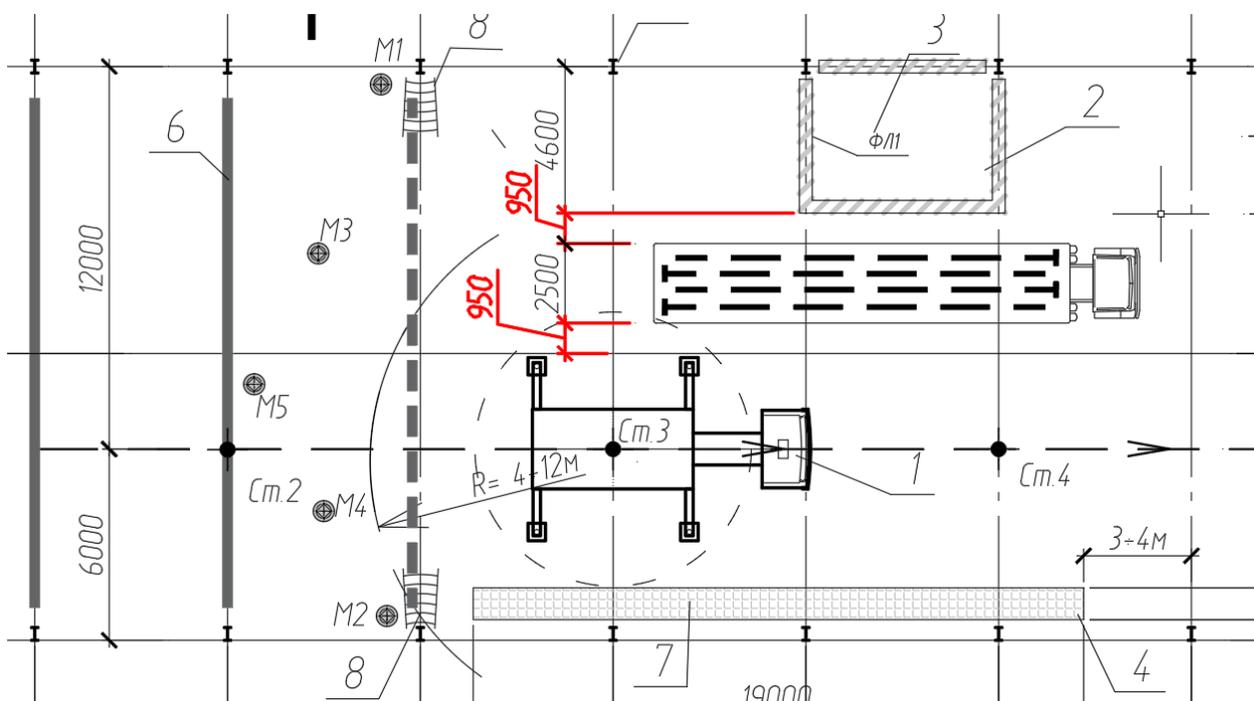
Схема организации рабочего места при монтаже ферм в пролете А/Б
